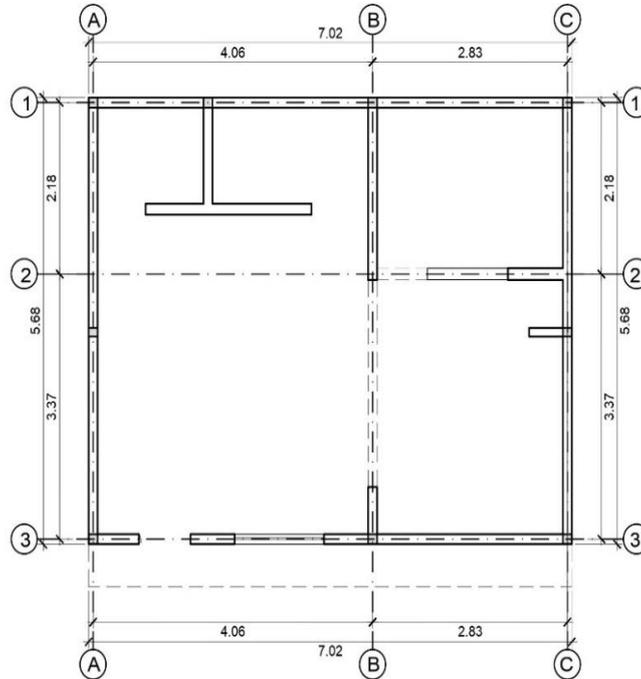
Ejes de la primera planta de la vivienda autoconstruida
